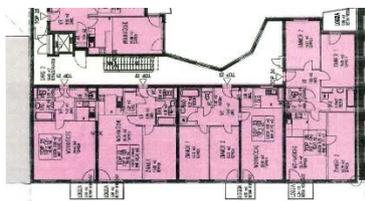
Wohnungen im 3.Obergeschoss, Bauteil West
